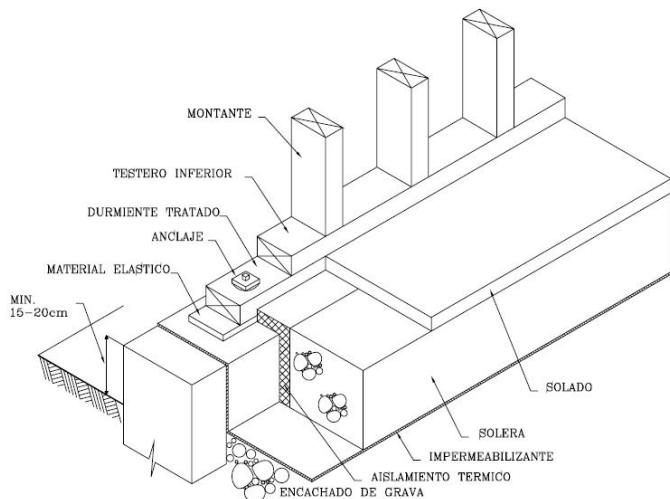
Detalle de unión sistema de entramado ligero con terreno y solera (<https://www.maderascasais.com>)
